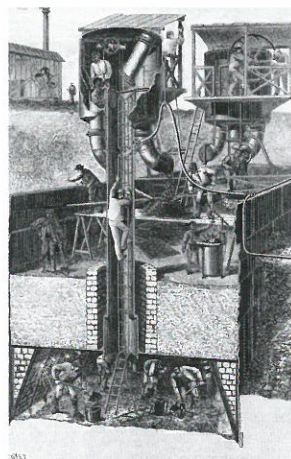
Sistema construtivo utilizado para a construção das fundações da torre nos pilares junto ao rio Sena.
